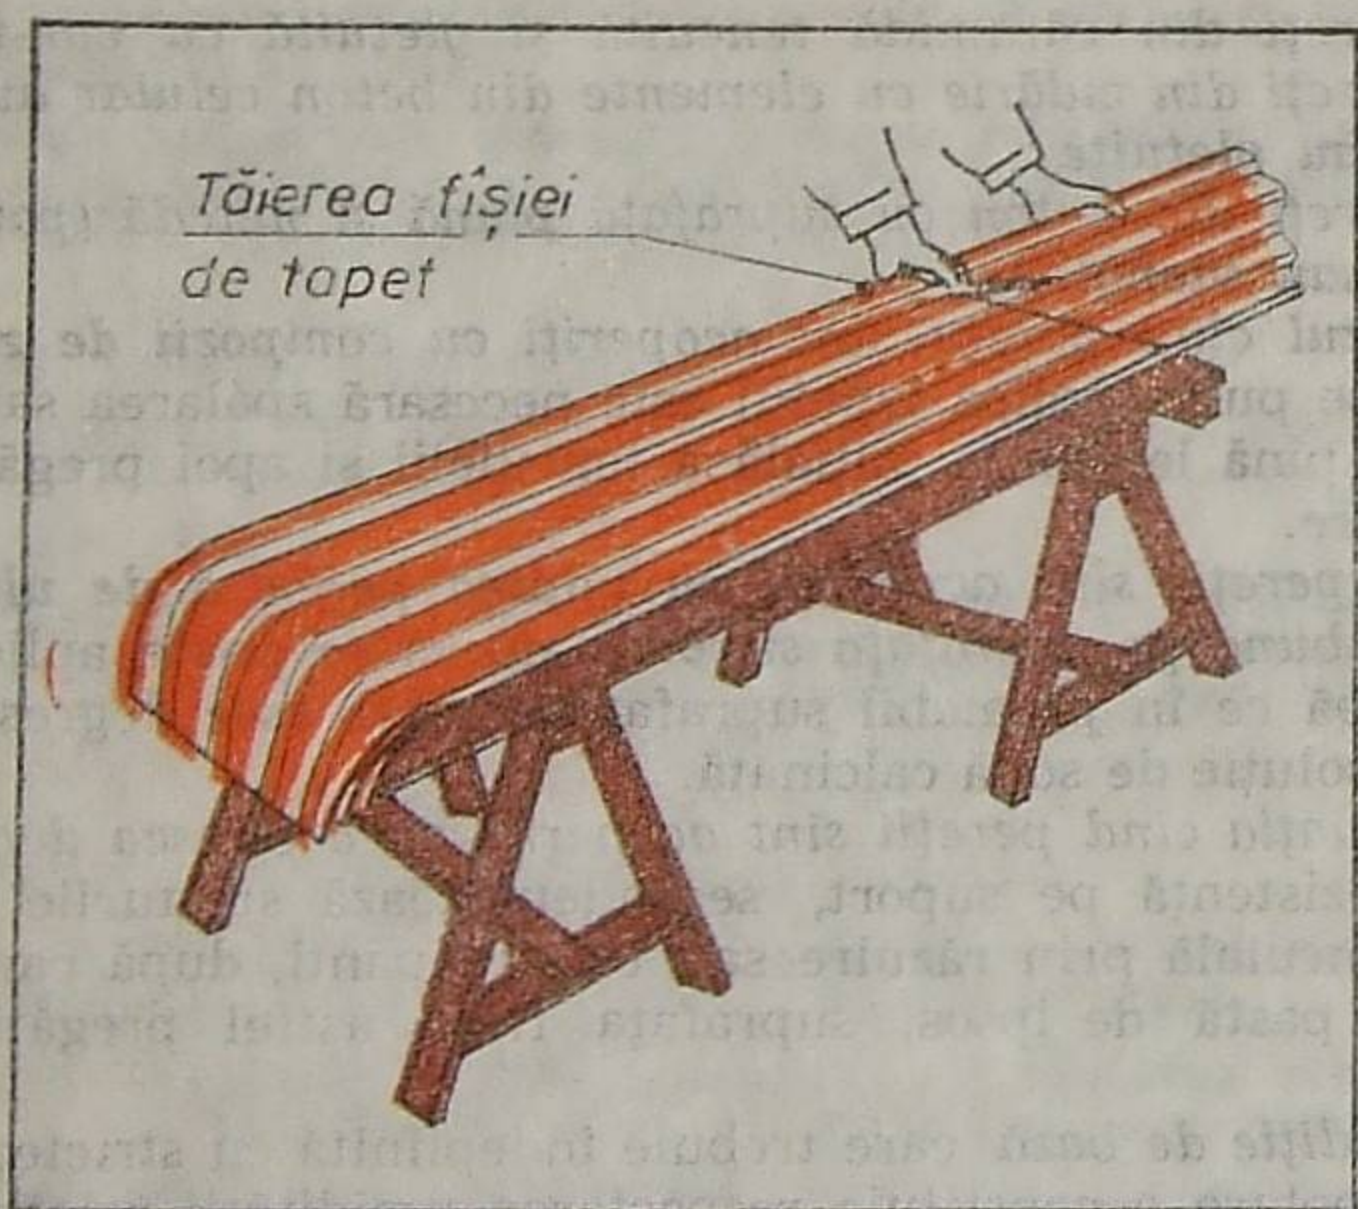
Planșeta de lucru pe capre de lemn.
